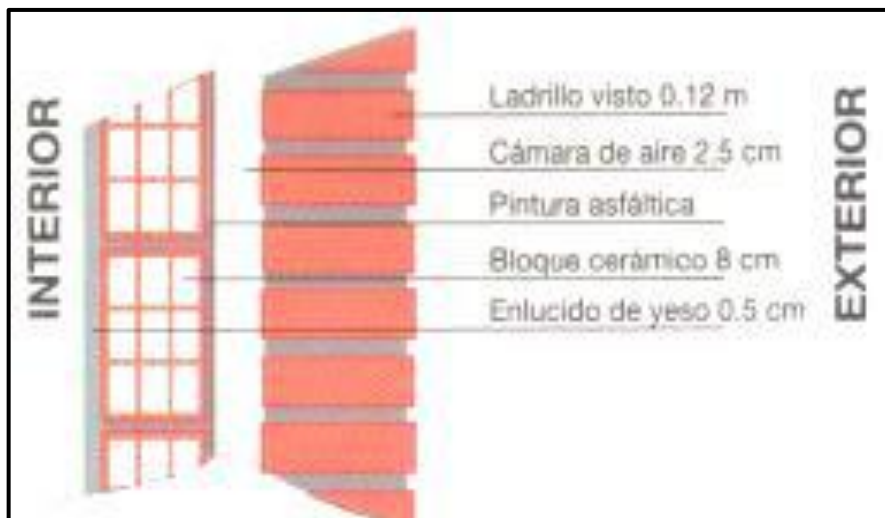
Muro con cámara de aire con espesores parciales. Fuente: <http://www.sistematicasa.com.ar>
